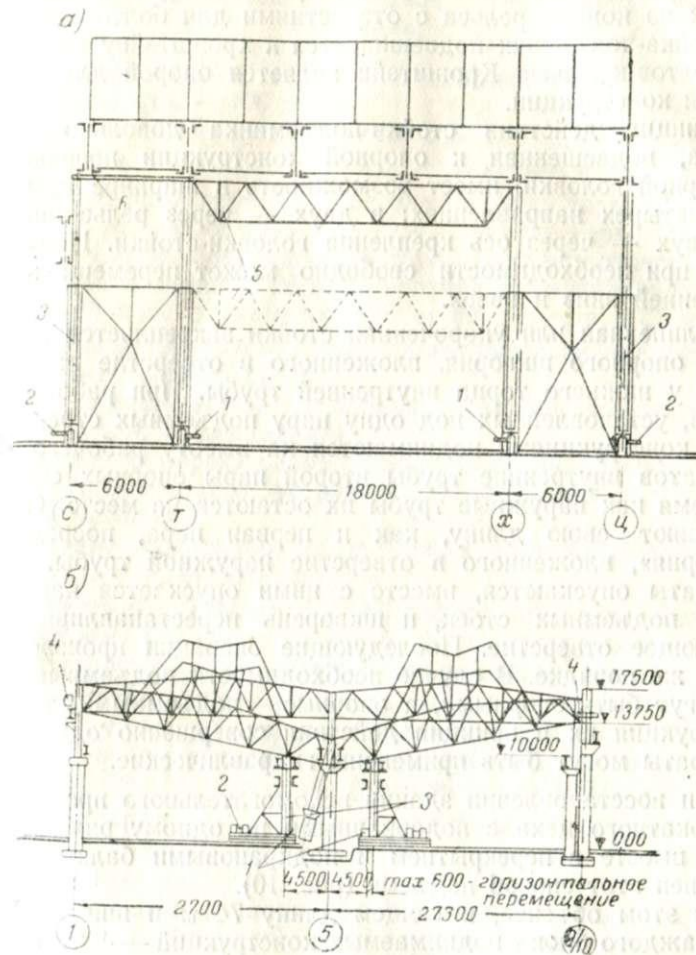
Схема подъема металлоконструкций при помощи телескопических подъемных стоек: а — продольный разрез цеха; б — поперечный разрез цеха; 1 — гидравлический домкрат грузоподъемностью 20 т; 2 — гидравлический домкрат грузоподъемностью 10 т; 3 — телескопический подъемник грузоподъемностью 20 т; 4 — направляющие; 5 — поддерживающая ферма; 6 — поддерживающая балка
